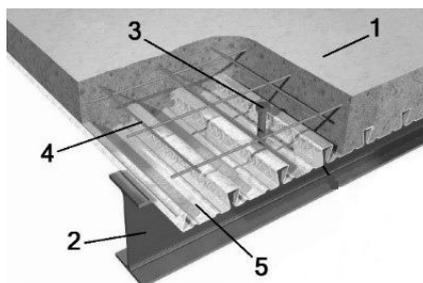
Вид монолитной плиты перекрытия по профнастилу по металлическим балкам (1-бетон, 2 - стальная балка, 3 – стаболт, 4 - сетка, 5- профилированный настил)
